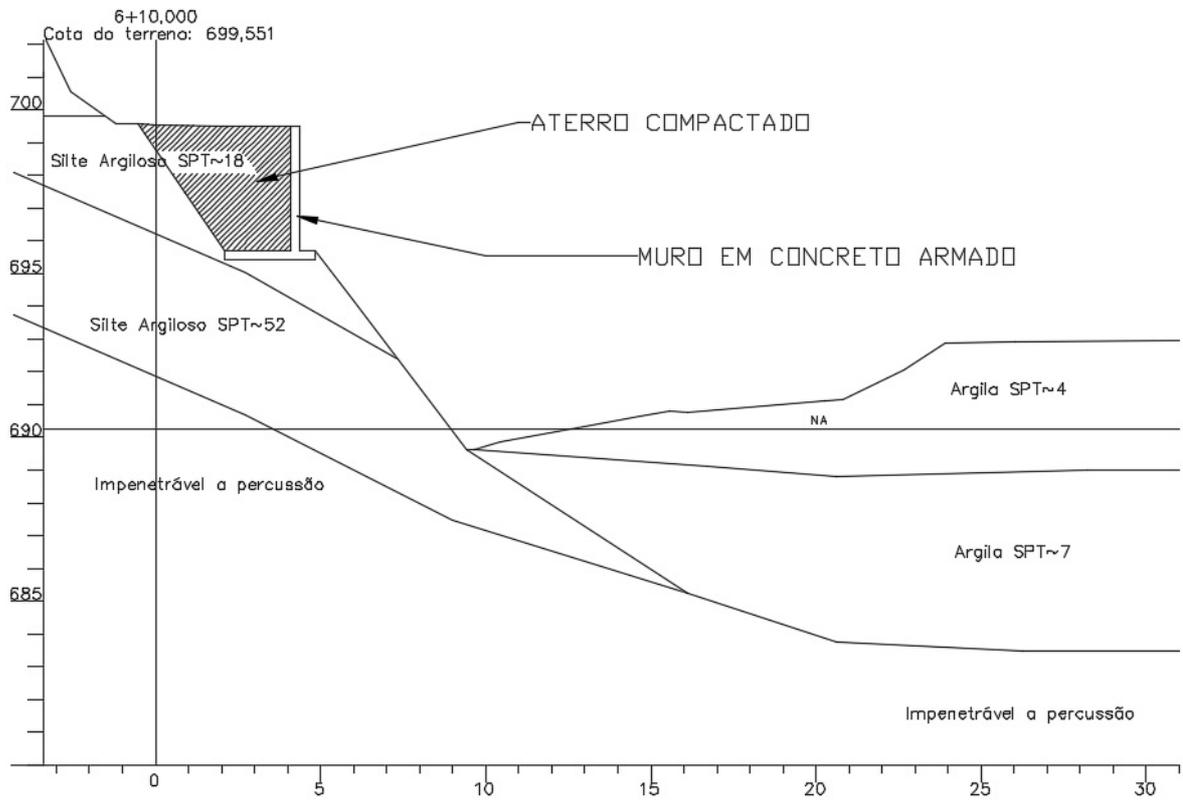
Contenção com Muro de Concreto Armado – Seção Tipo
